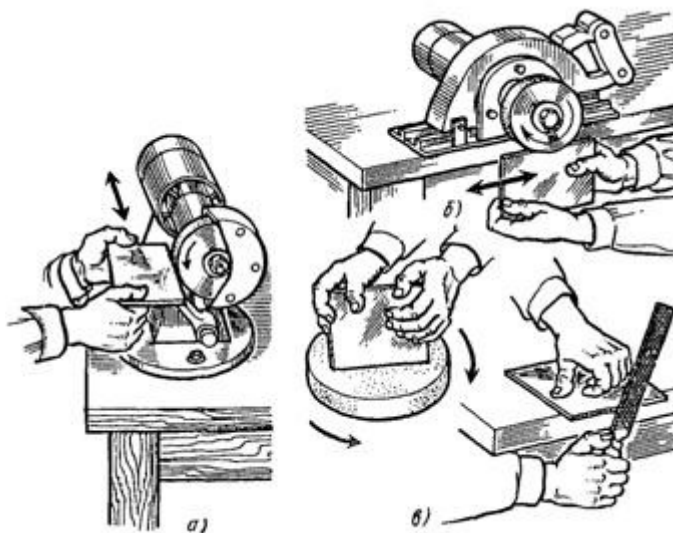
Выравнивание (подтачивание) кромок плиток: а - на стационарном точиле, б - на переносном инструменте с шлифовальным кругом, в - вручную шлифовальным кругом или рашпилем
